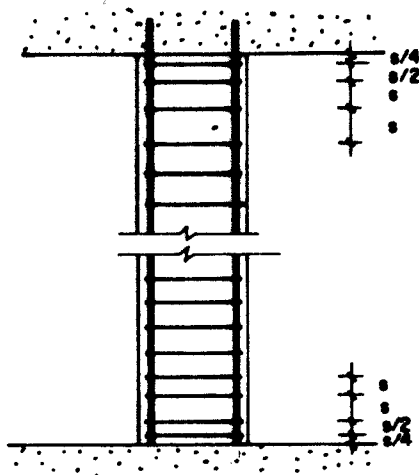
Estribos adicionais nas extremidades do pilar⁽²⁰⁾.
